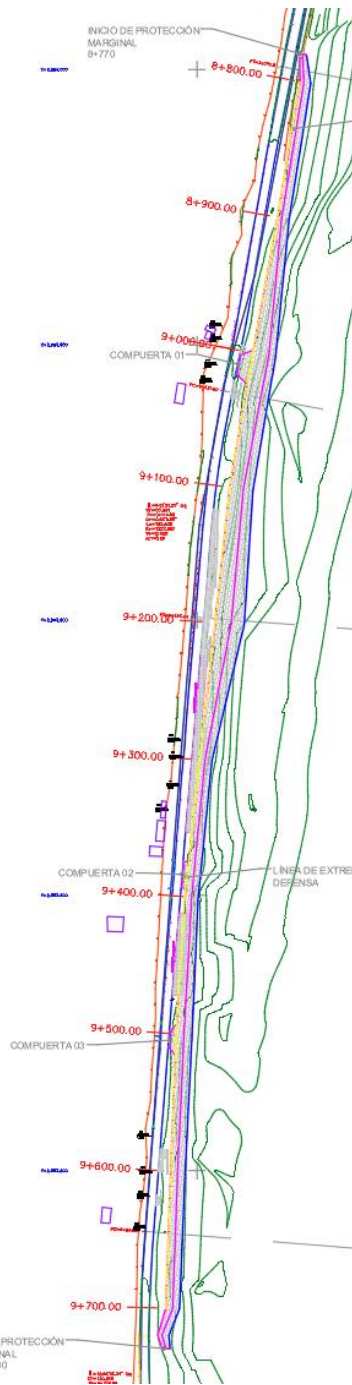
Vista en planta de la propuesta de solución, protección marginal a talud.
